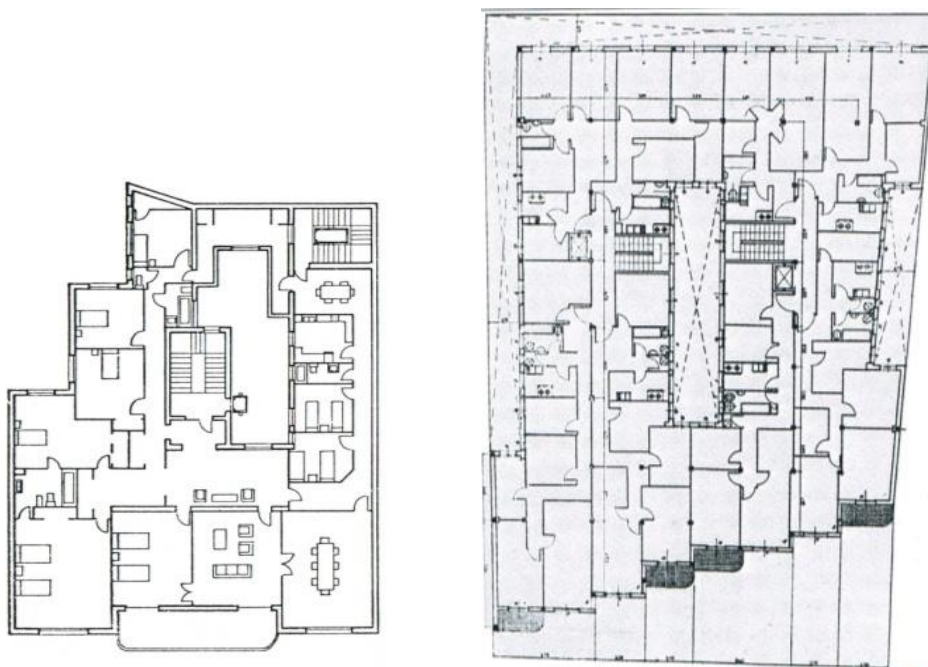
Planta tipo en C/ José Abascal, 53.
